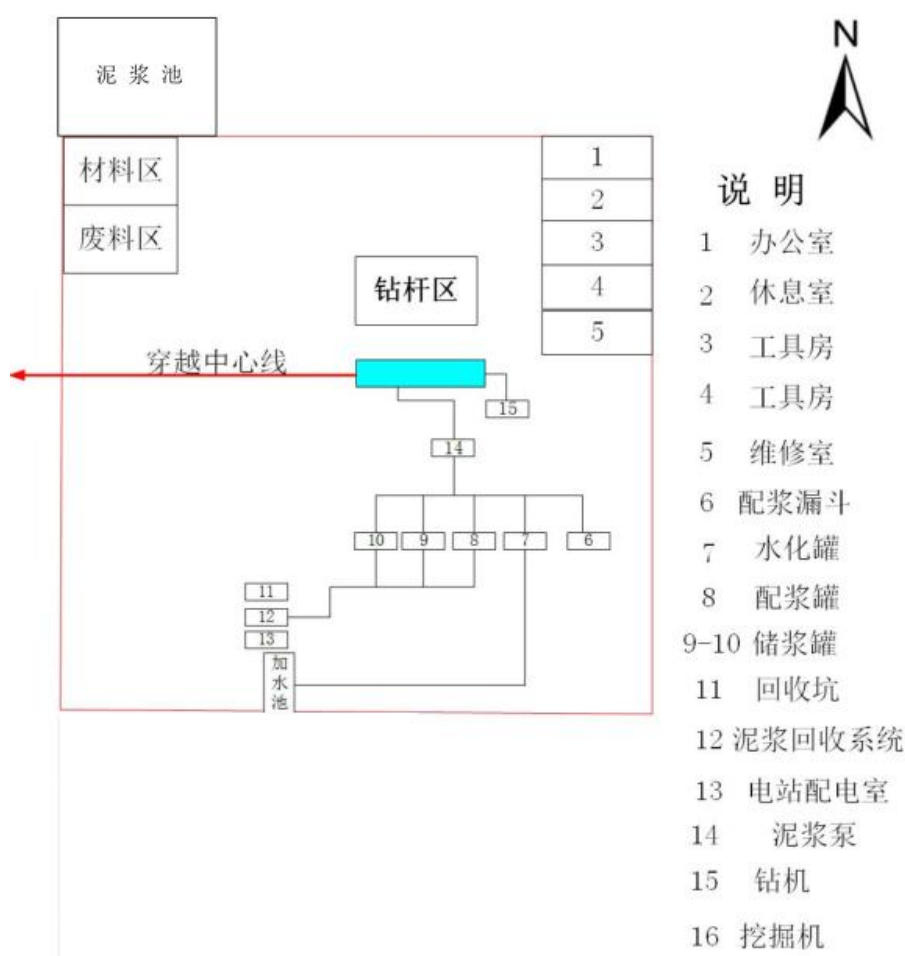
定向钻穿越施工管入土端平面布置示意图
